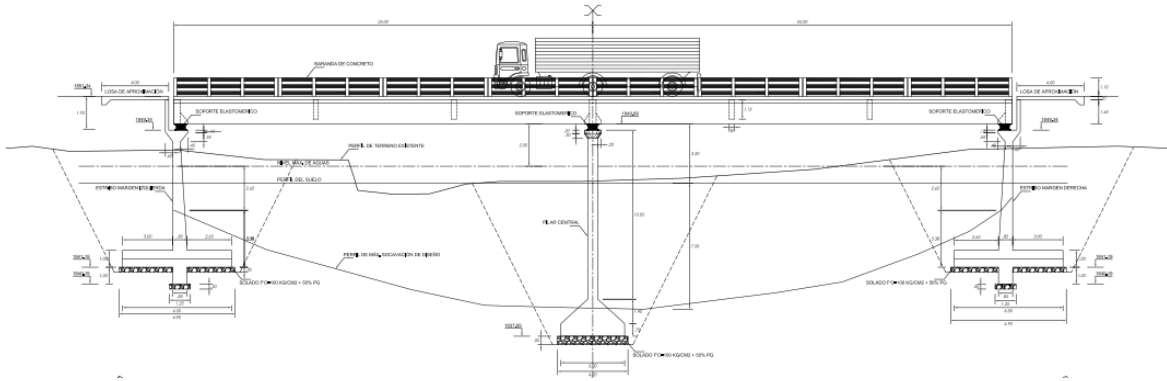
Elevación puente La Capilla. (P-1 Anexo4)
